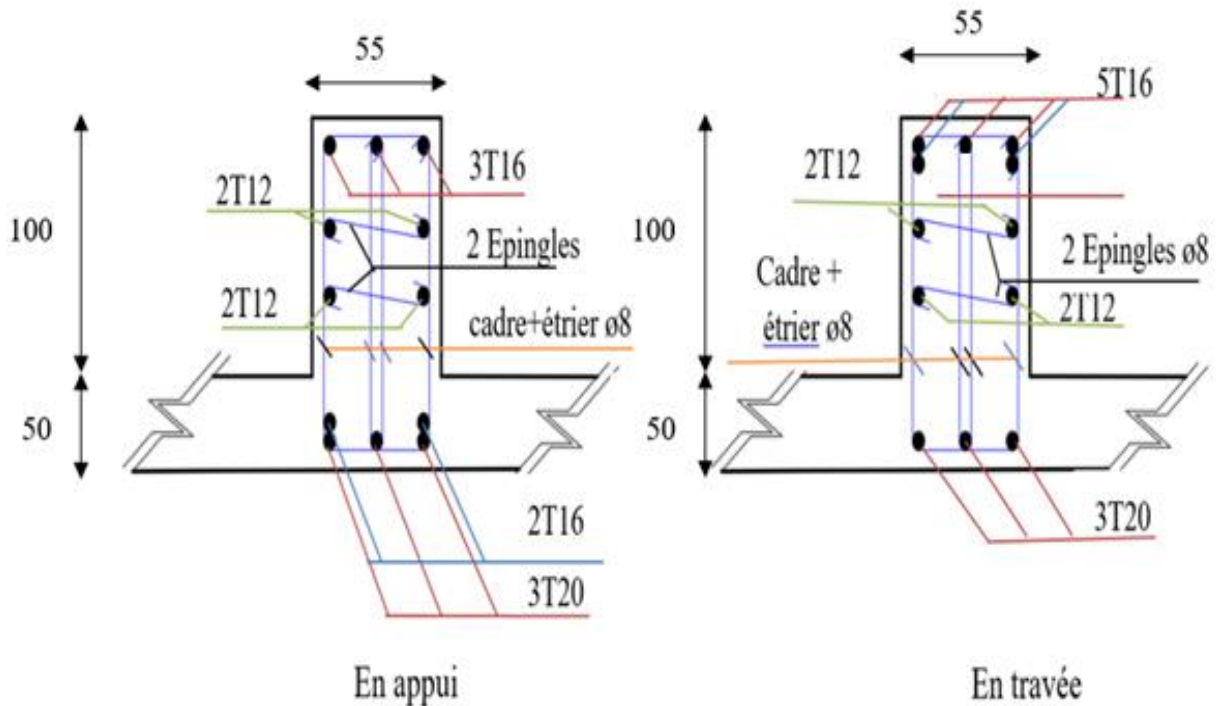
Ferrailage de la poutre secondaire en travée et en appui.
